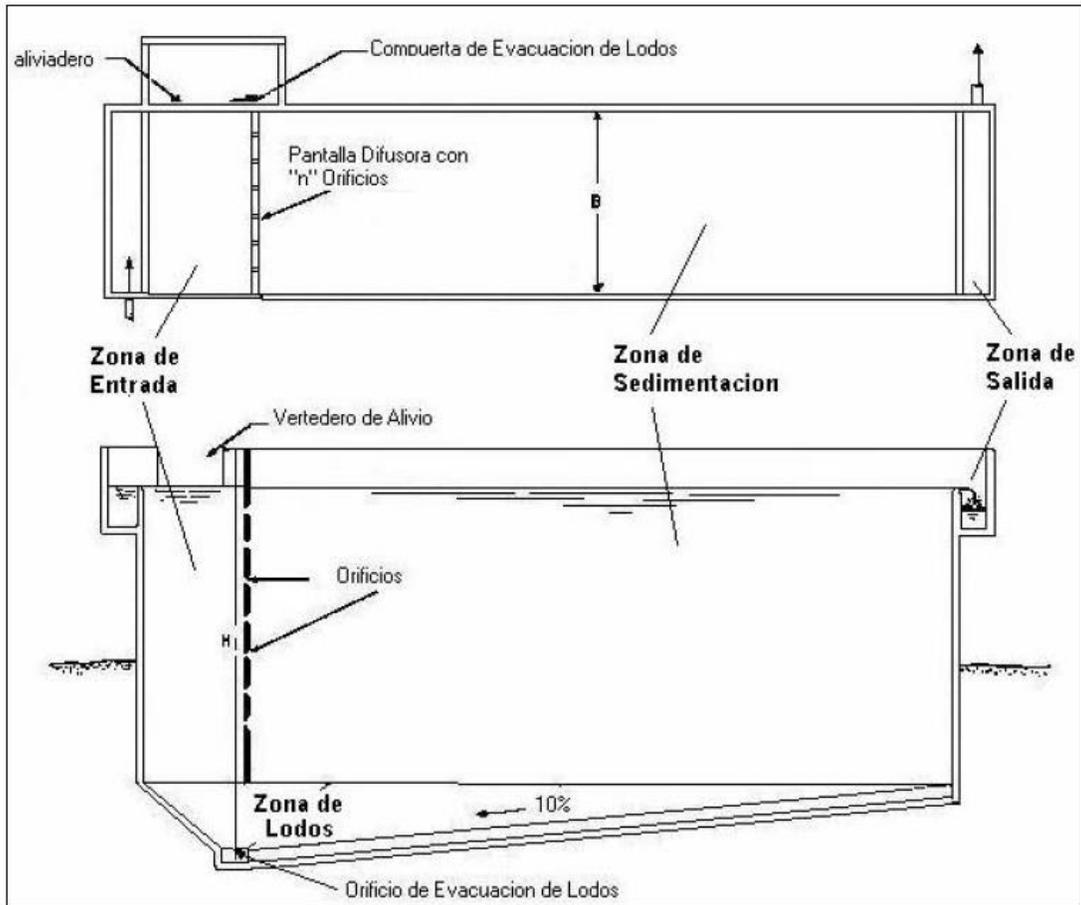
Sedimentador tipo (Planta y corte longitudinal).
